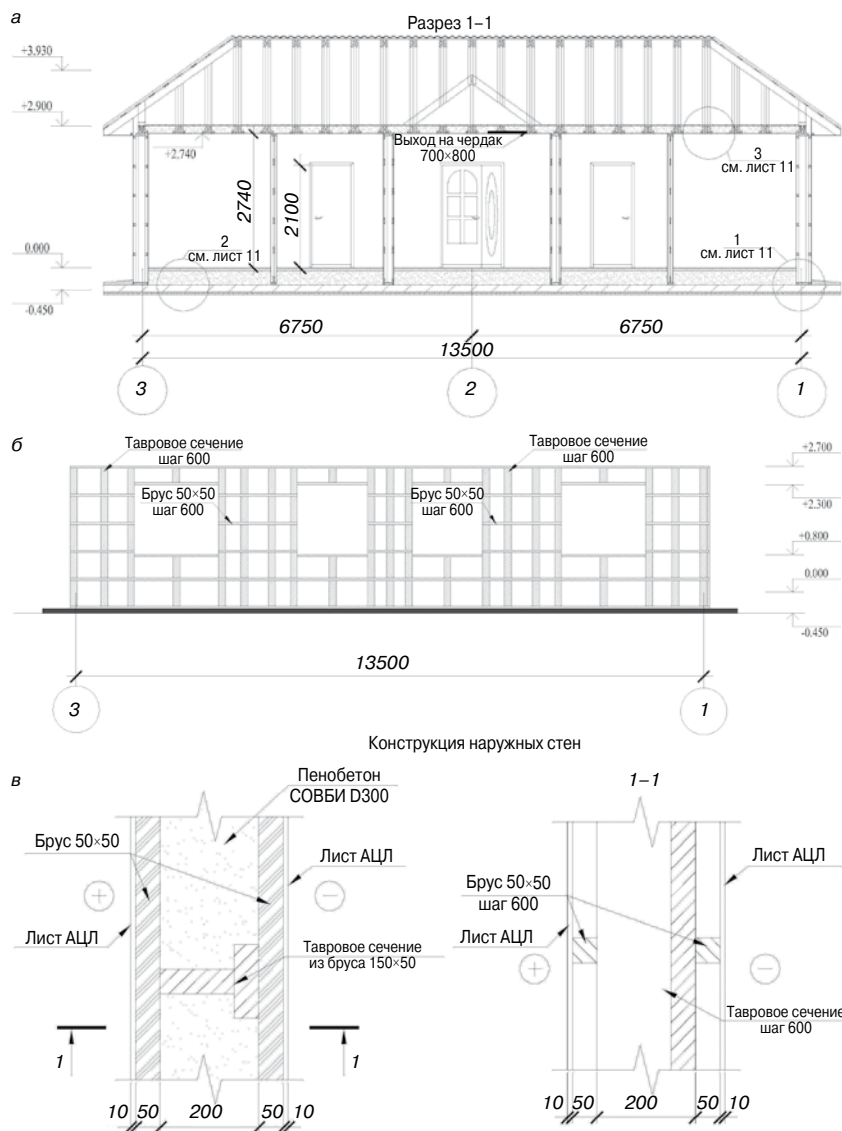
Примеры и узлы каркаса типового проекта: а – типовая раскладка каркаса; б – типовая конструкция наружных стен; в – разрез здания с деревянным каркасом и утеплением пенобетоном
